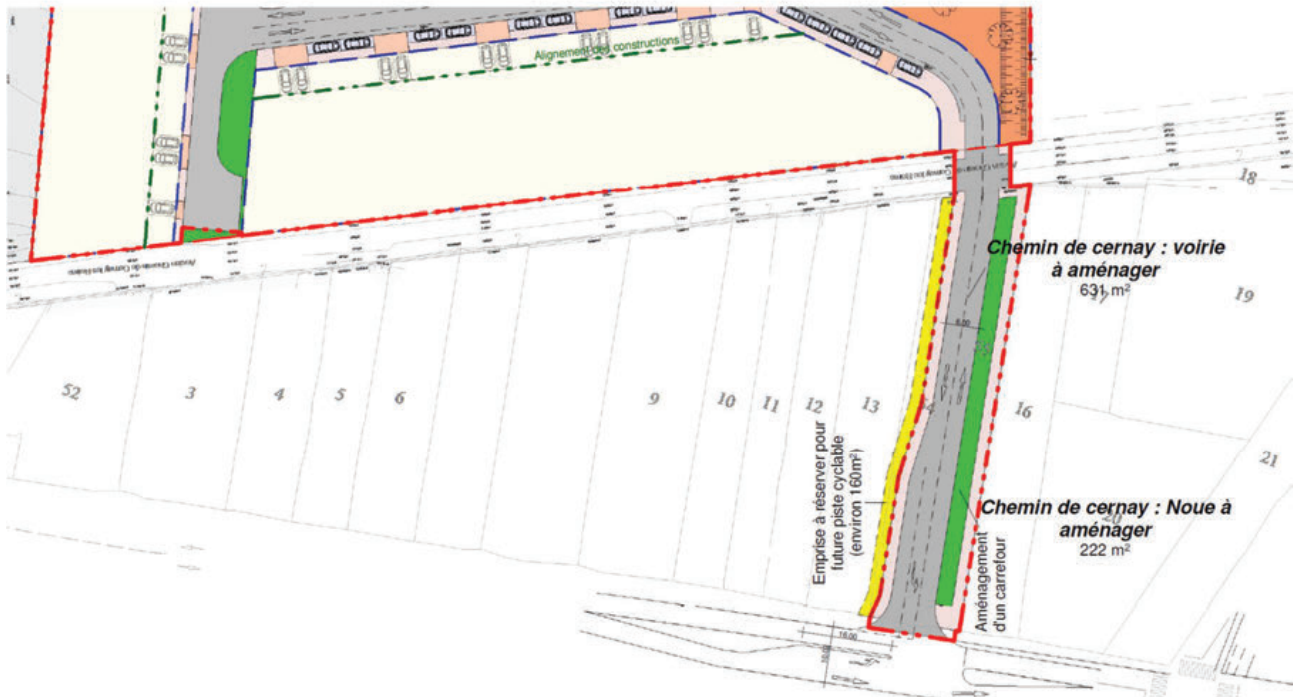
Plan de détail de la voirie d'accès (AWO)
